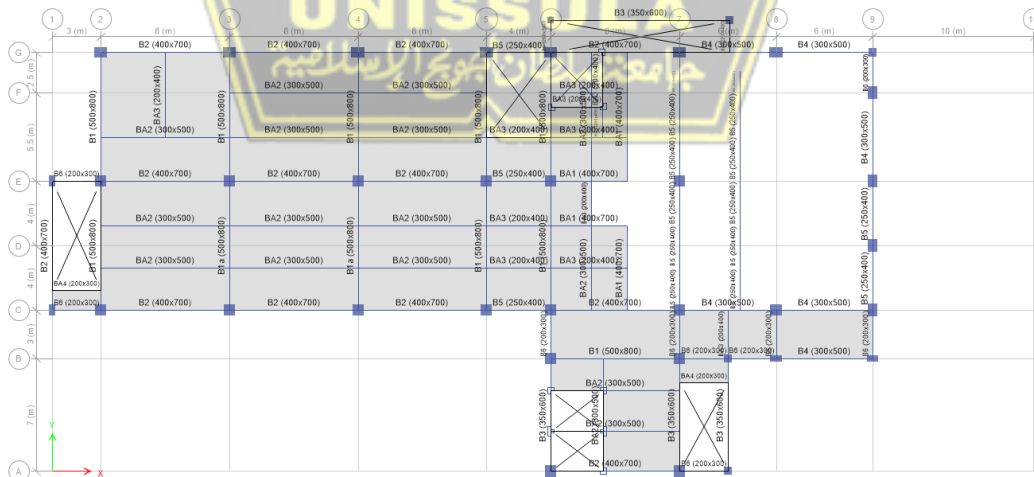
Denah Lantai 3 (EL. +8.00)
